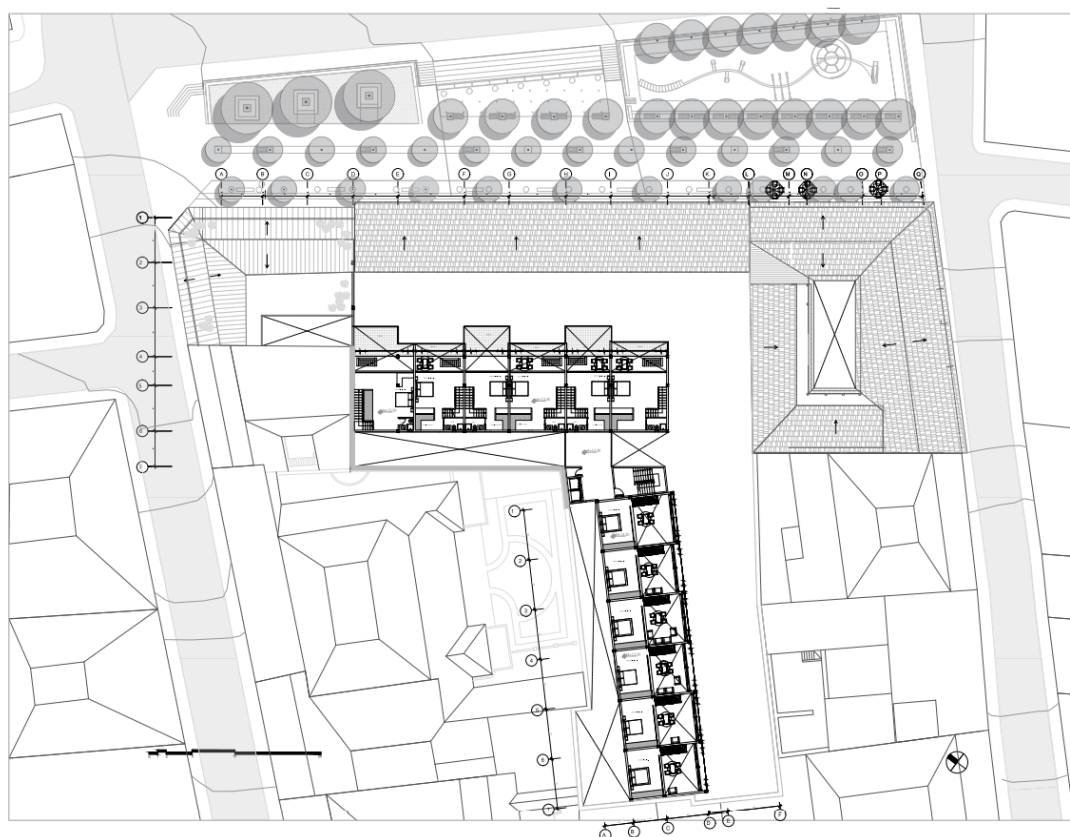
Planta piso 4. Elaborado por Nacevilla 2020
